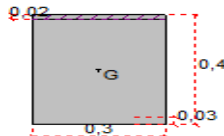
Ferrailage de la poutre principales a état ACC.
